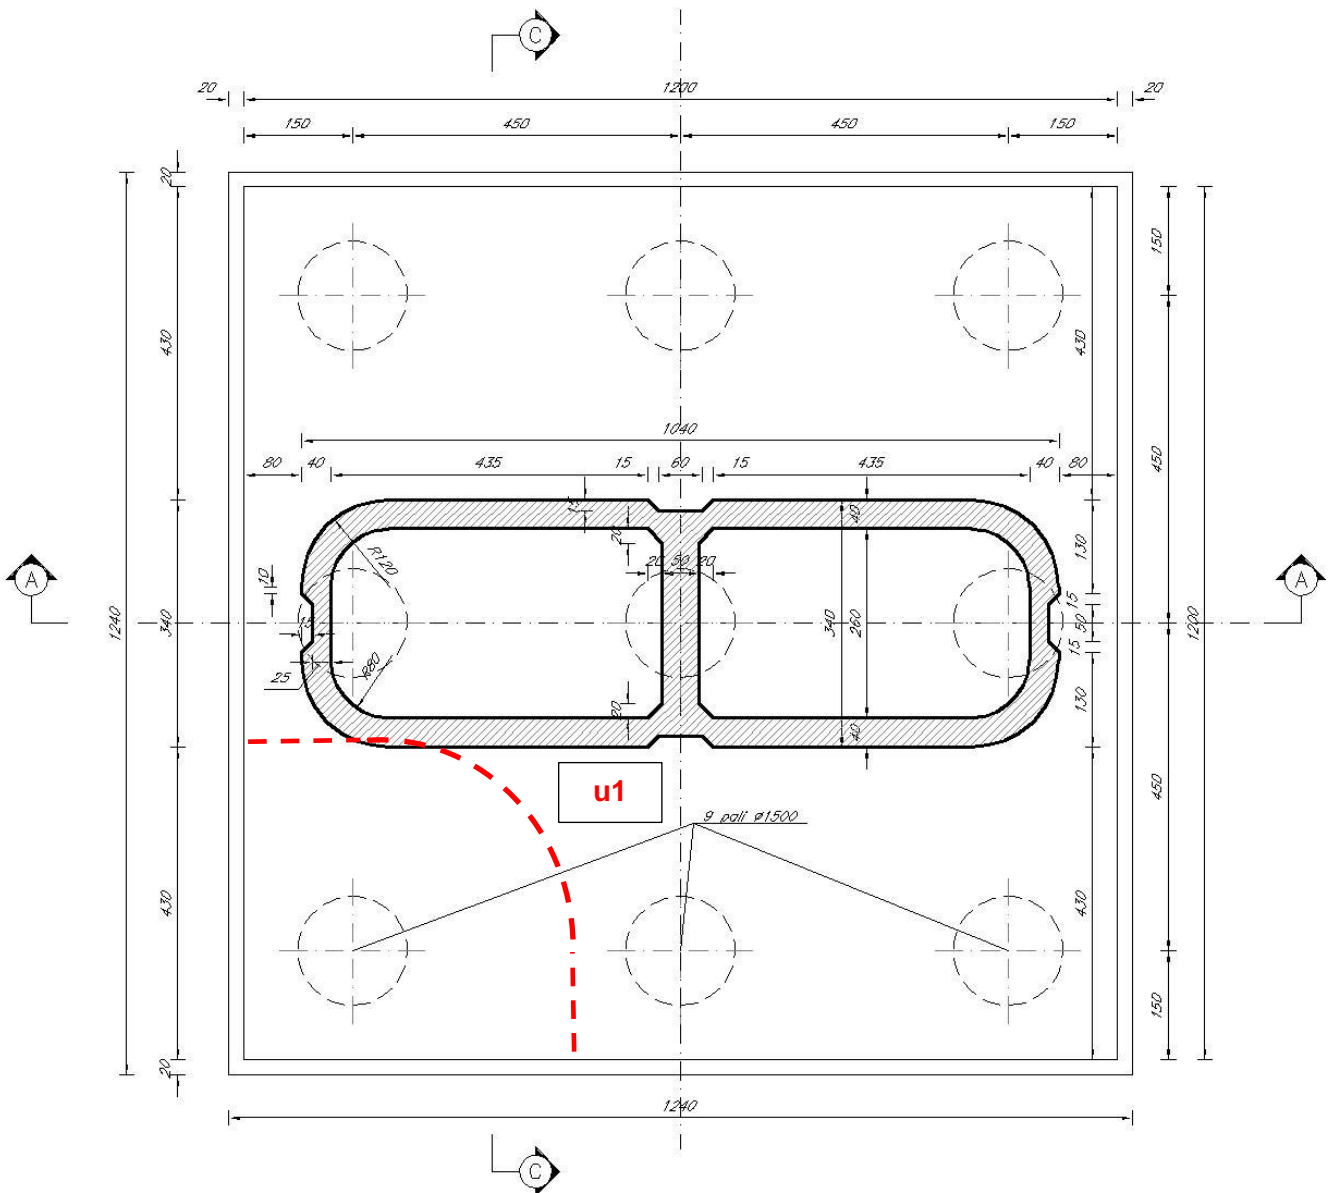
Plinto di fondazione – perimetro efficace per verifica a punzonamento per azione verticale trasmessa dal palo di spigolo
